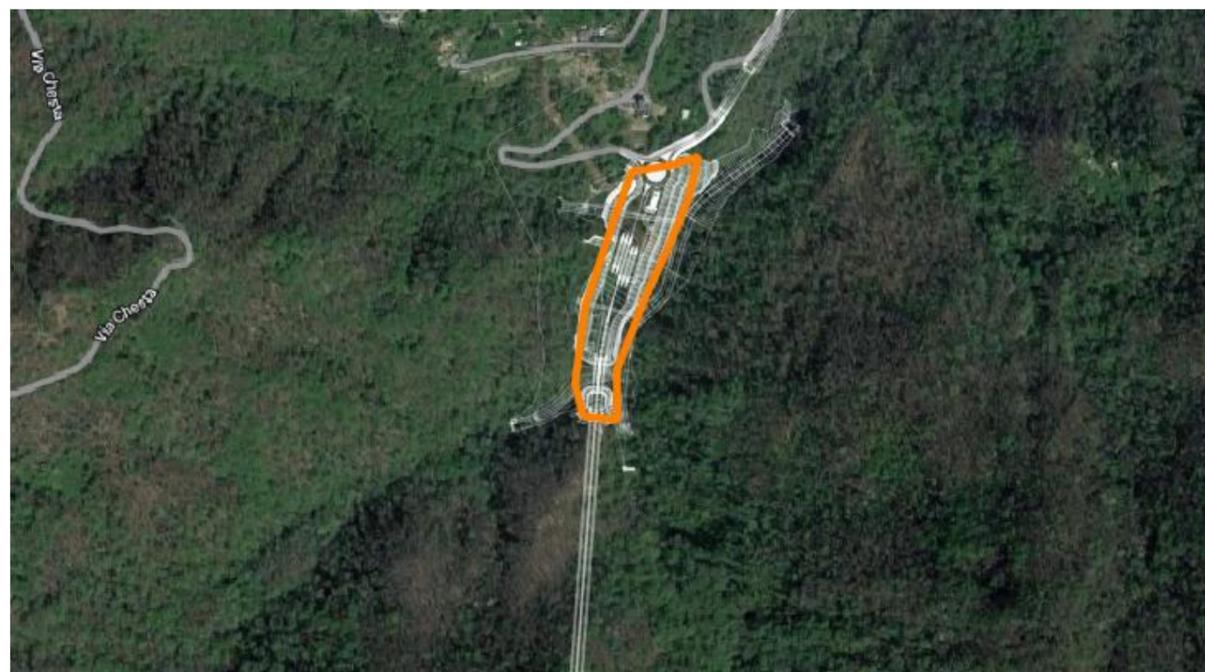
Localizzazione Cantiere Imbocco Nord galleria Fontanabuona
